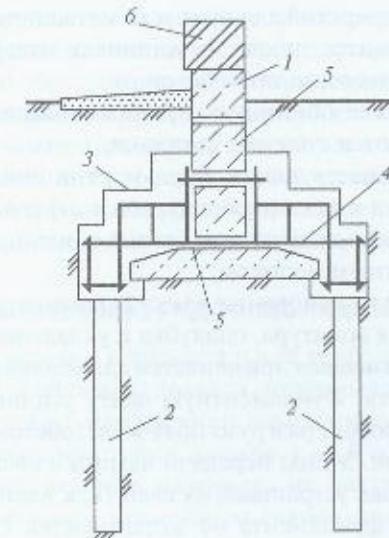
Усиление ленточных фундаментов передачей нагрузки на сваи:
